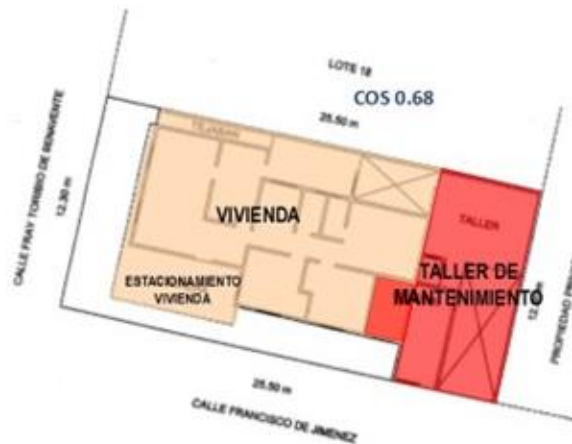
Planta Arquitectónica Actual del Predio
